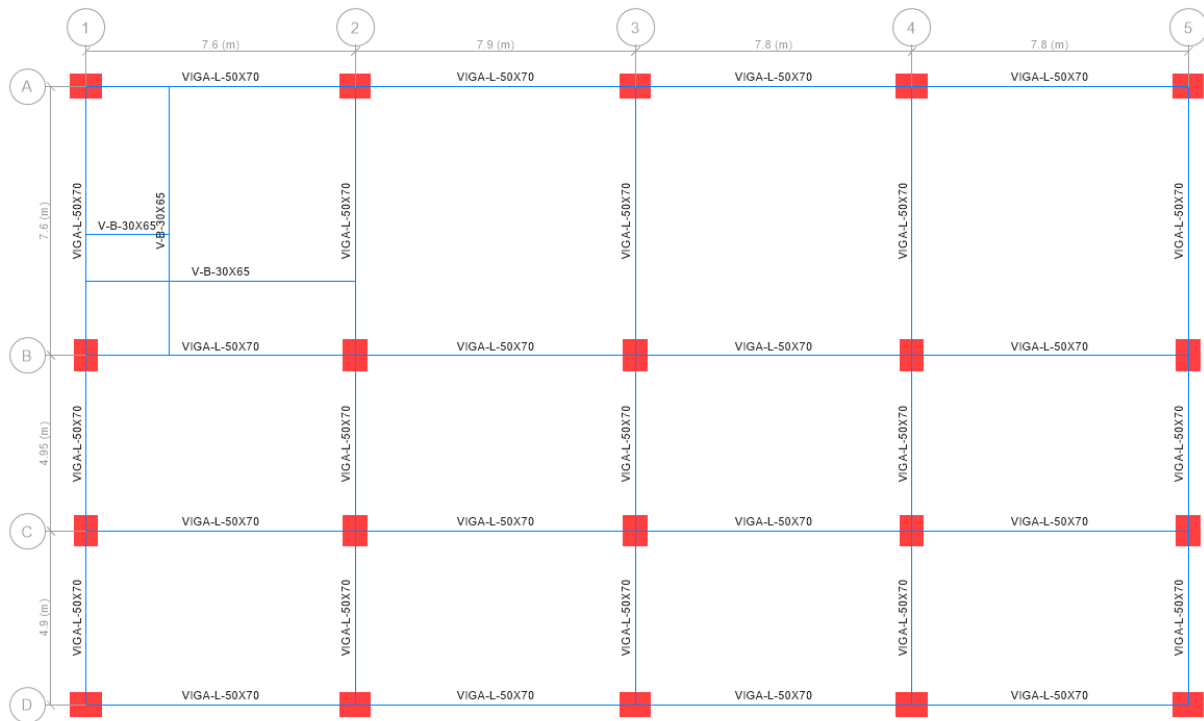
Vista en planta de vigas para el caso de estudio 2 - Etabs
